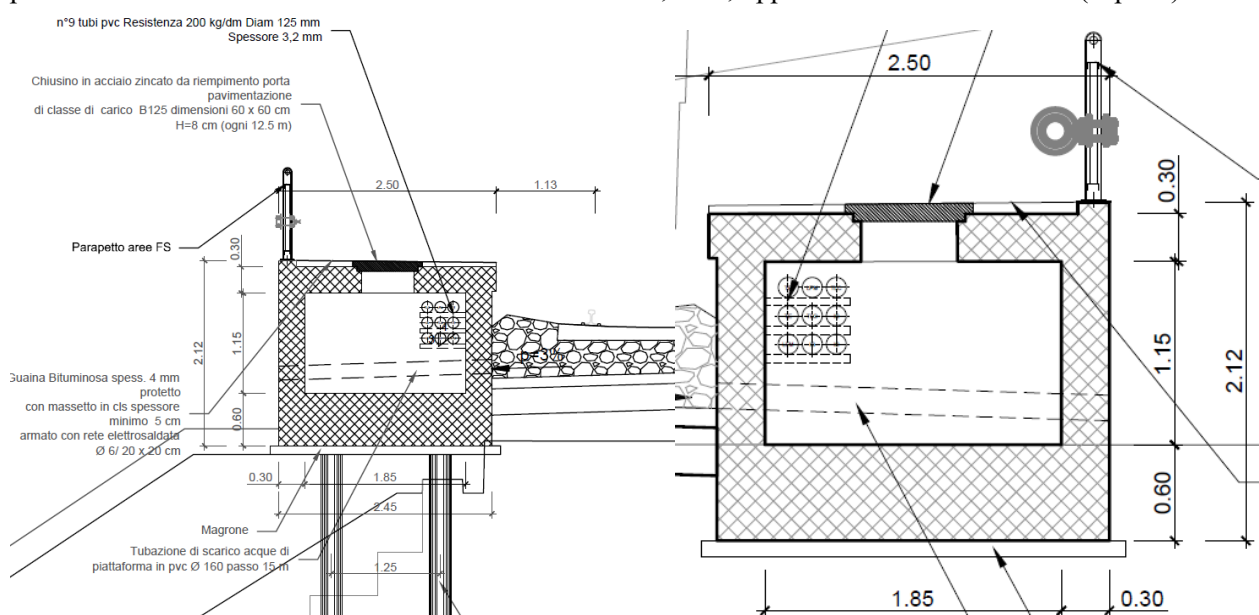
Marciapiedi FFP tipo A (a sx) e tipo B (a dx)
